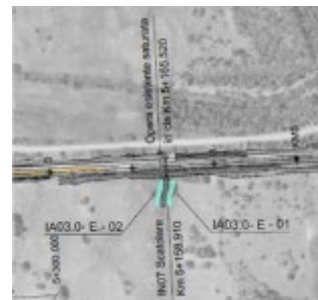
IN07 – Stralcio planimetrico opere a verde revisionato
